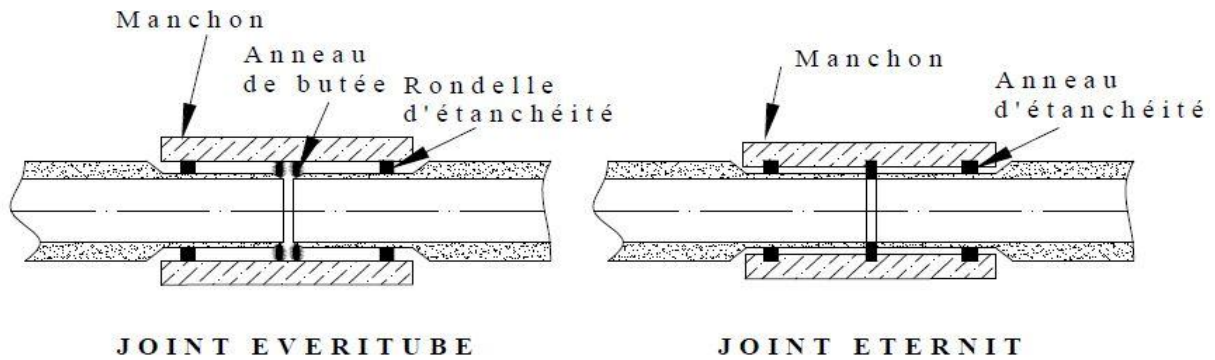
Joints sur tuyaux en amiante ciment.
